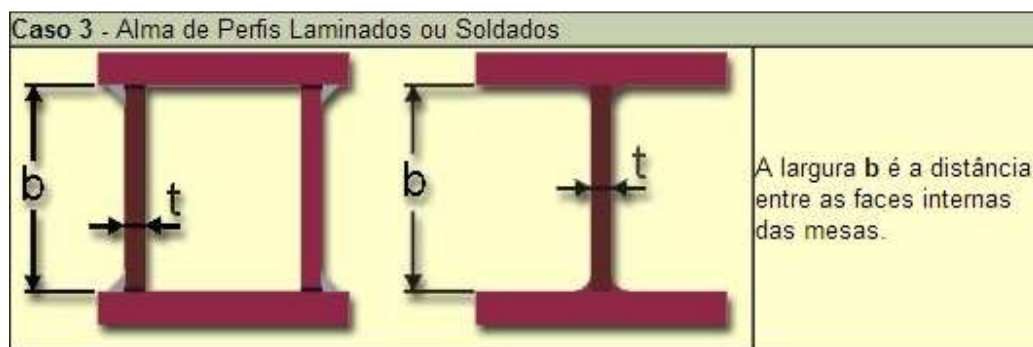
Elementos enrijecidos, caso 3: Alma de perfis laminados ou soldados [20].
